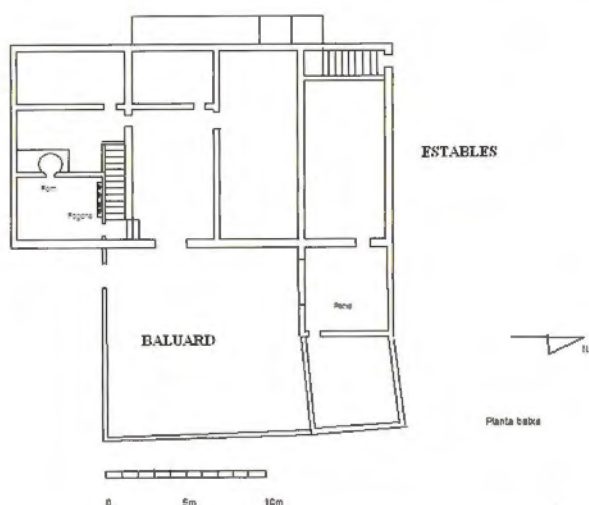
Distribució d'espais planta baixa, masia de l'alt Berguedà ramader.
